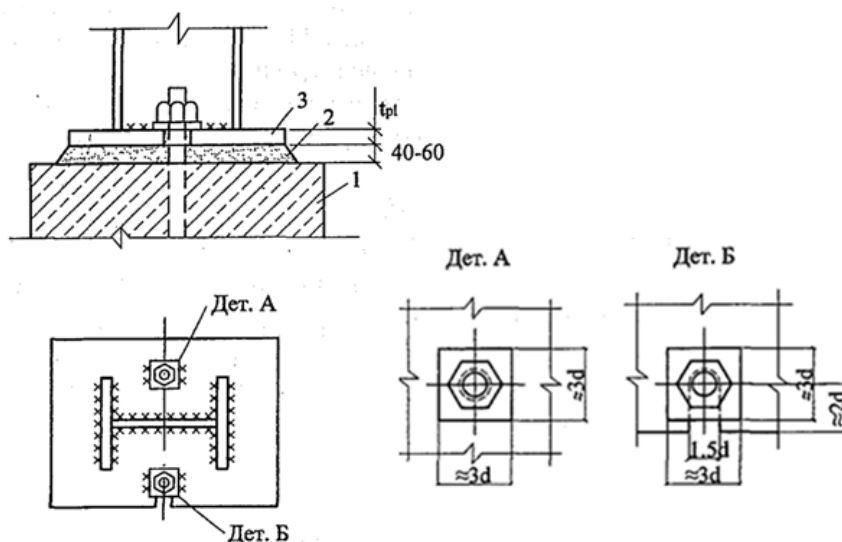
Шарнірне кріплення опорної плити бази колони до фундаменту:
